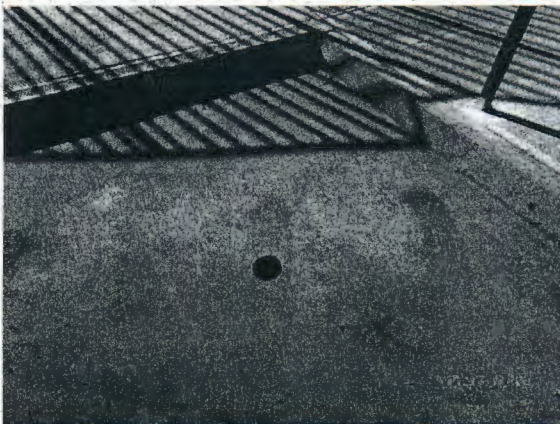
Fisuras en pavimento del estacionamiento vehicular, por calle Mateo Palacios.
